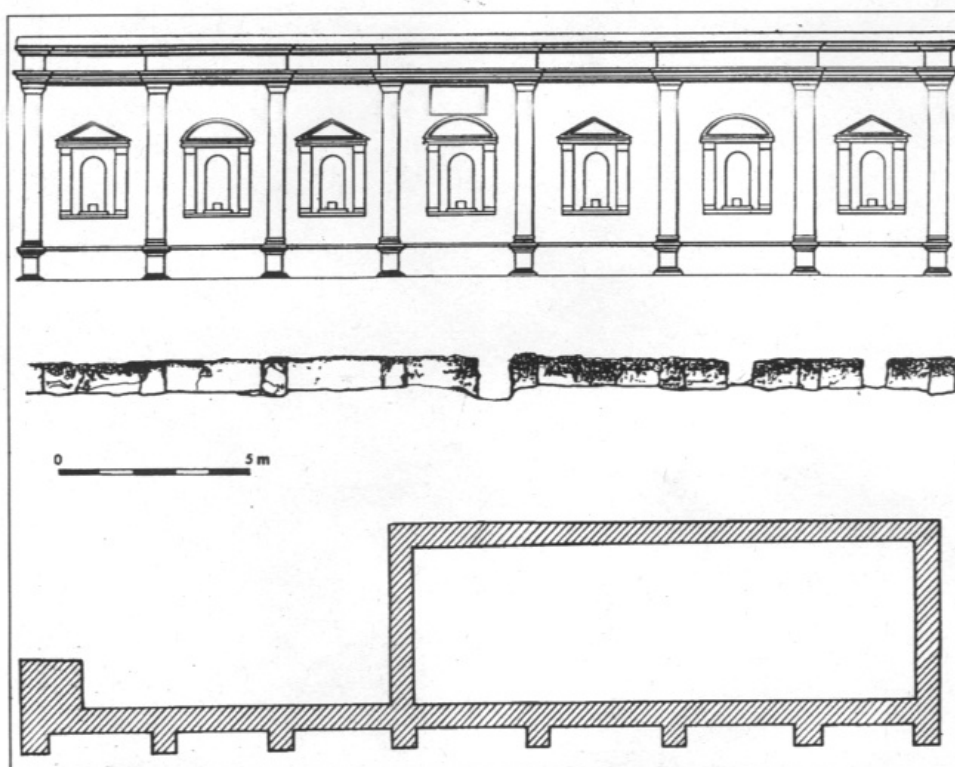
Complutum*. Planta, alzado y reconstrucción hipotética de la fachada del supuesto ninfeo
